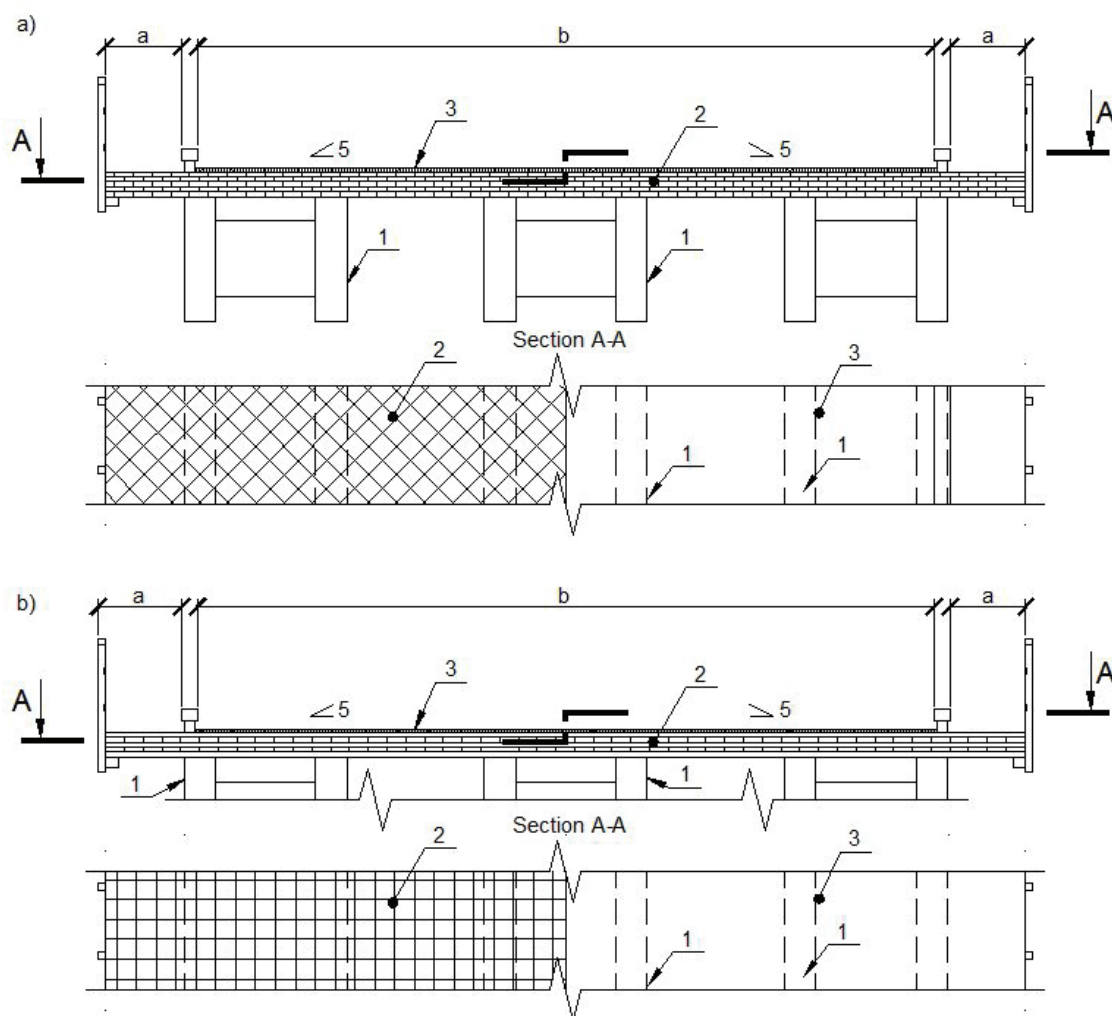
Конструкция пролетного строения с деревоплитой из перекрестных досок (ламелей):
